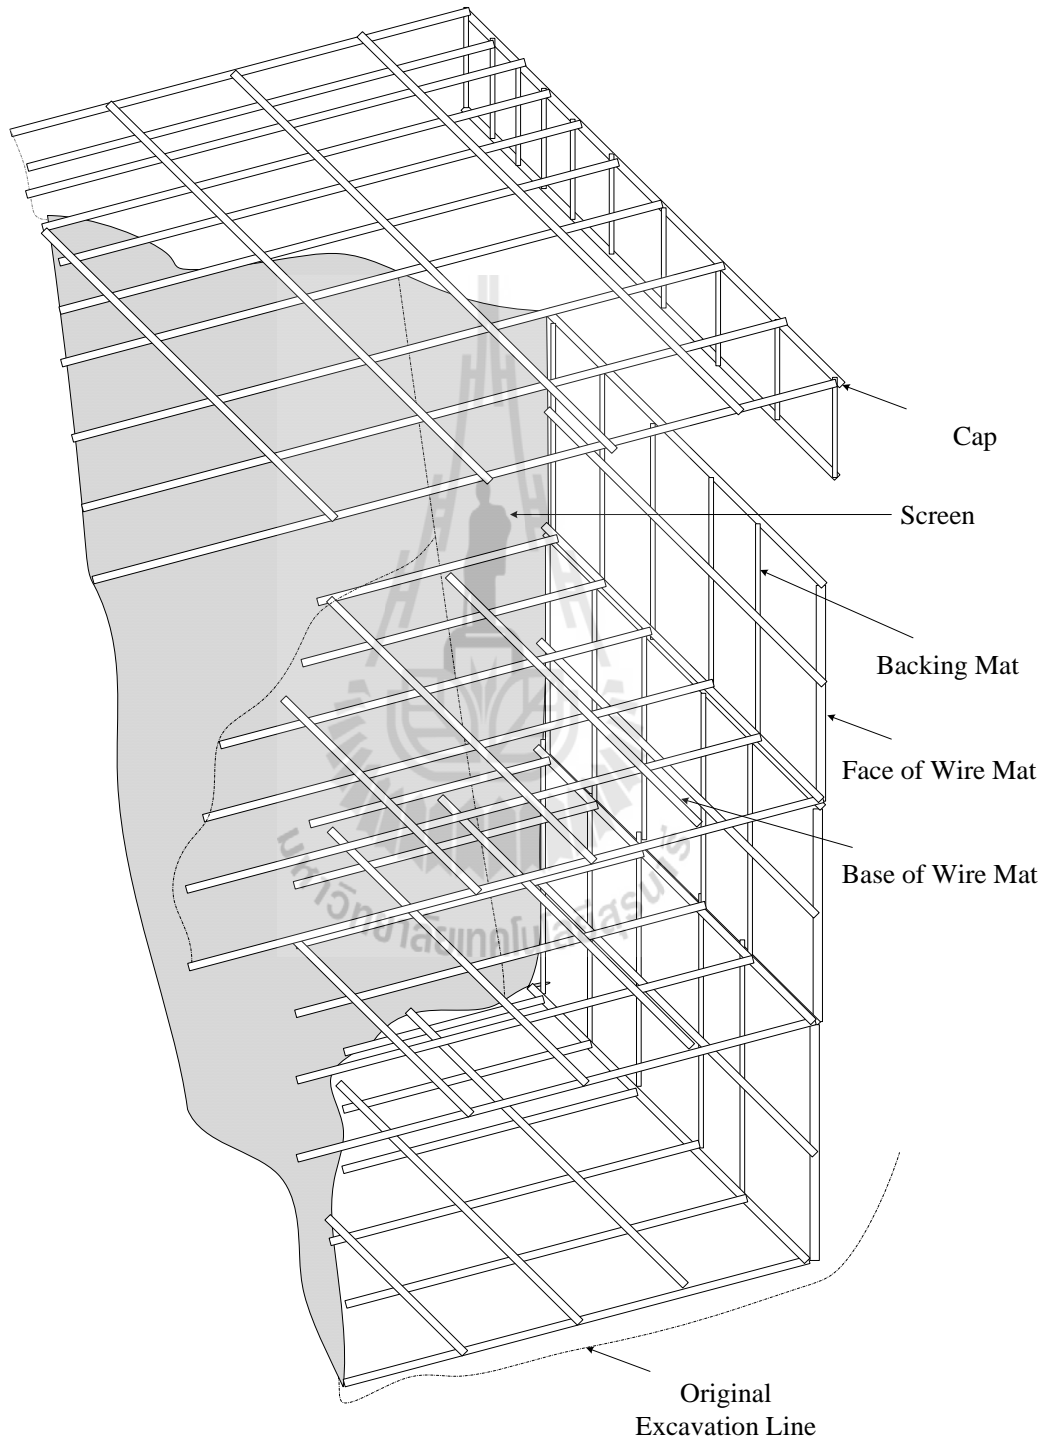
กำแพงกันดินแบบ Reinforced Earth (Reinforced earth wall)
